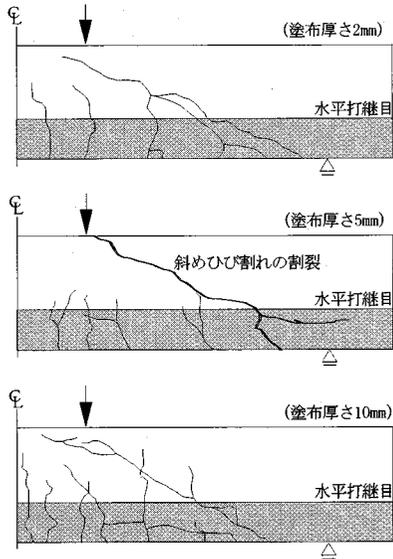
ポリマーセメントモルタルの塗布厚さを変化させた場合の水平打継目を有するRCはりの破壊時のひび割れ状況図
